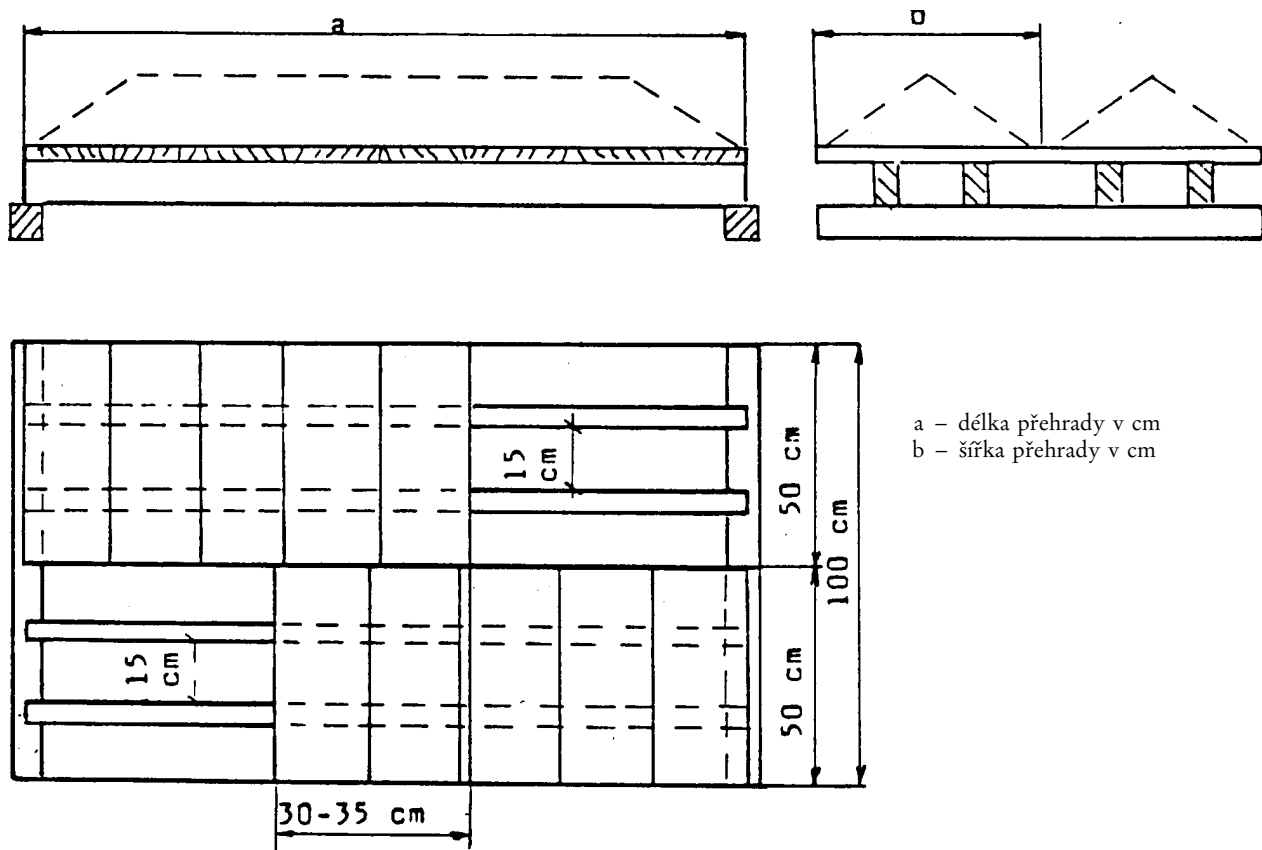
Příklad umístění korýtek ve světlem průřezu
